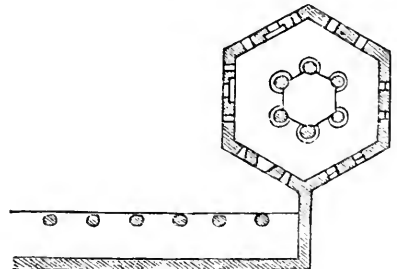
Grundriss des Baptisteriums zu Deir-Seta in Syrien (de Vogüé pl. CXVII).
